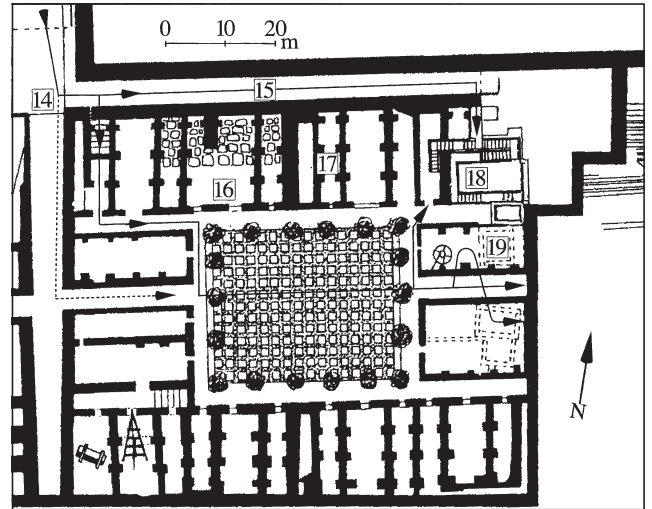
Grundriss des Palastes II. – (Nach Küchler, Jerusalem 226).
